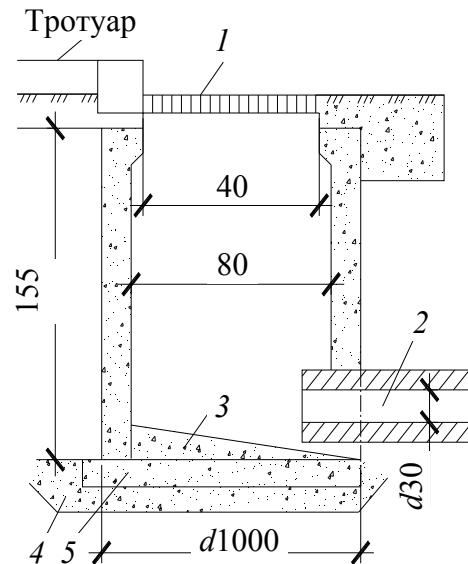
Схема устройства железобетонного дождеприемника:
